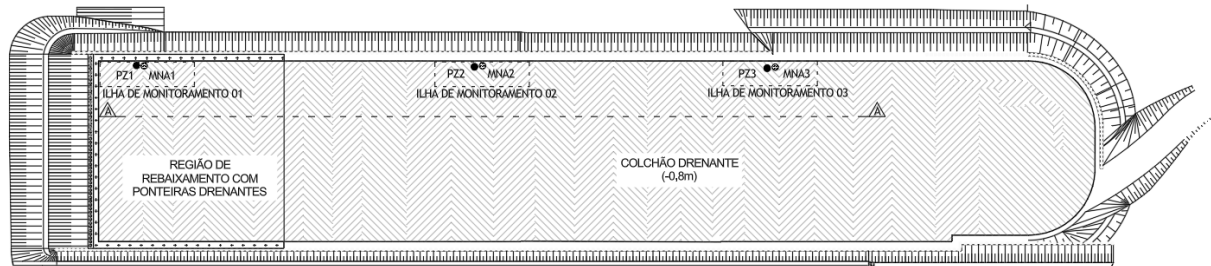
Planta do sistema de drenagem e rebaixamento do nível d'água.
